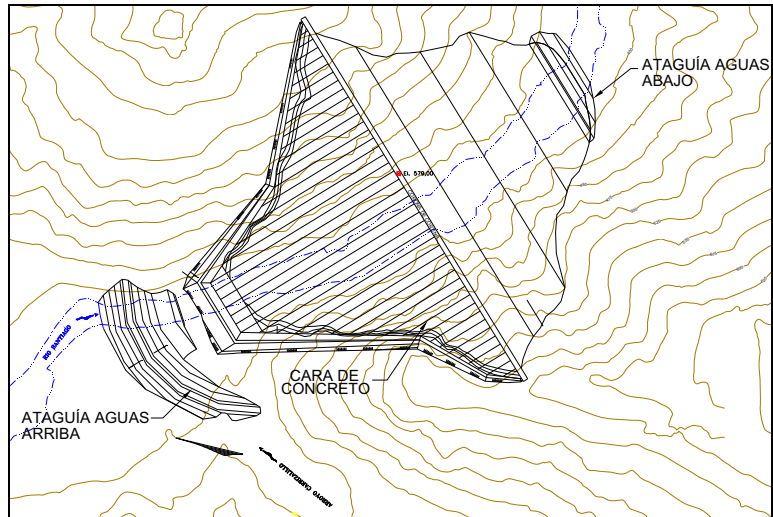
Planta de la cortina de enrocamiento con cara de concreto.
